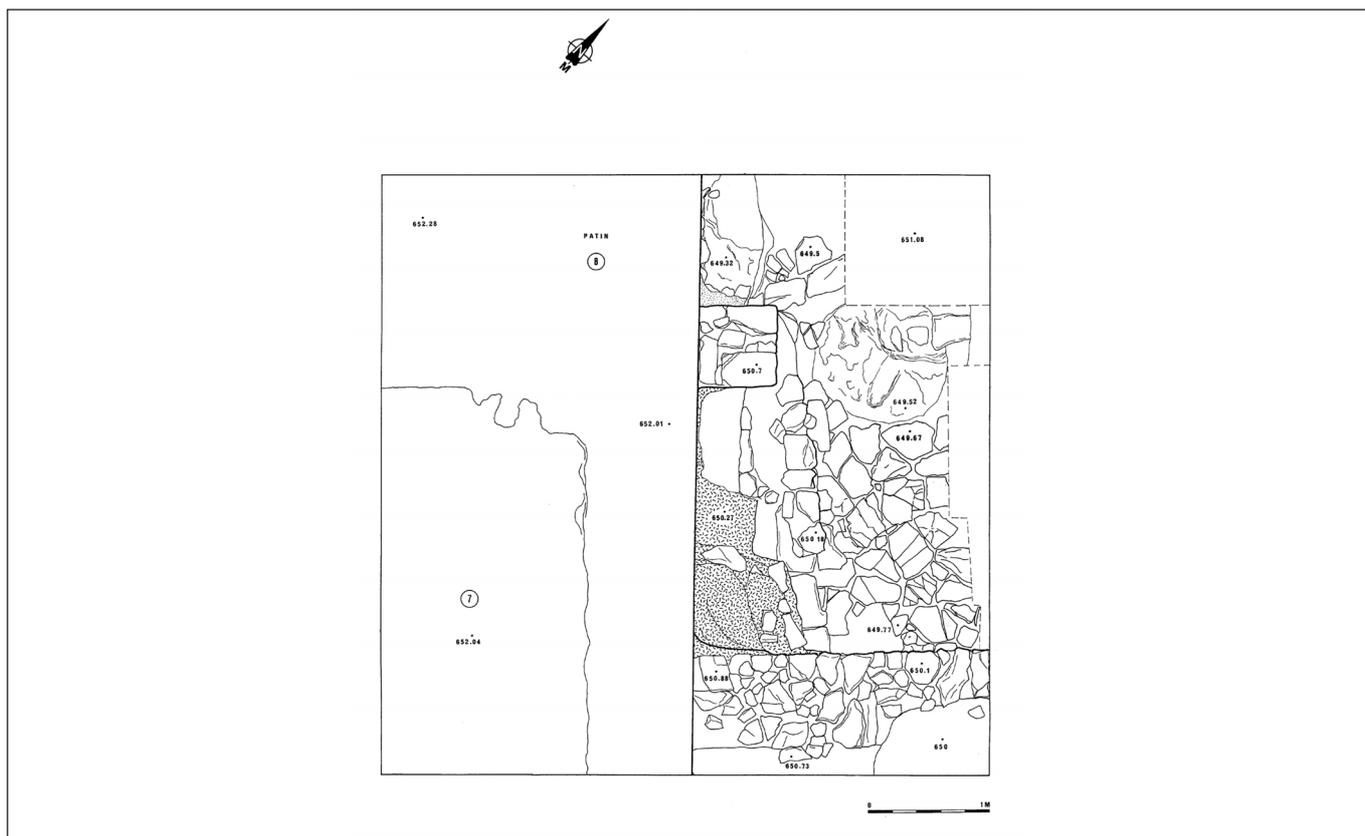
Sondeo 5. Planta general, con pavimento de losas de piedra, patín de la torre del Homenaje y estructuras adosadas al mismo.
